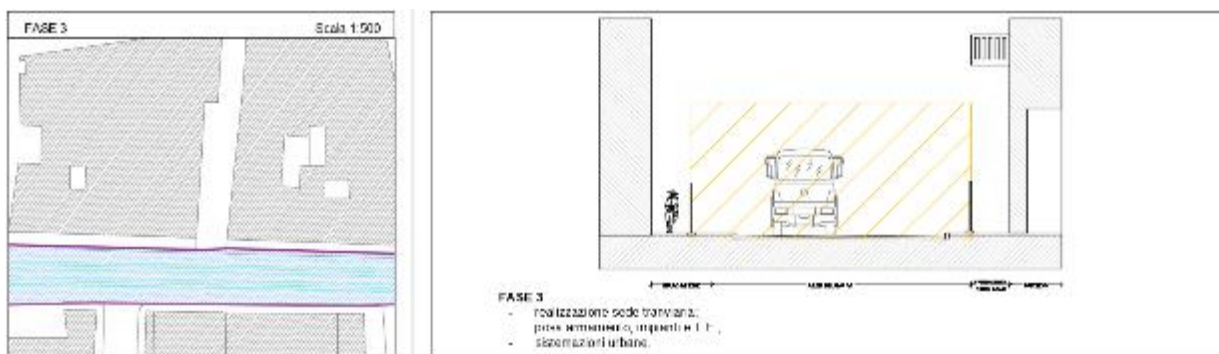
Tipologico cantiere con sede promiscua Fase 3
